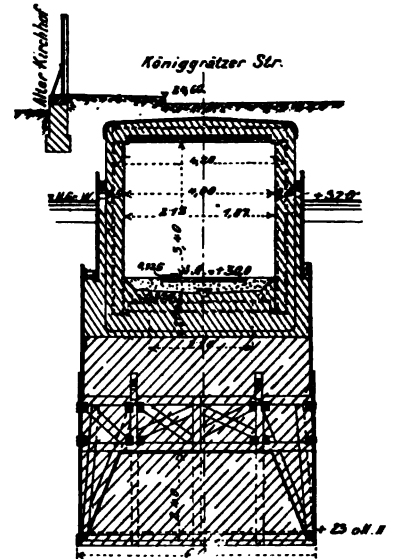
Querschnitt der Berliner Untergrundbahn unter dem Potsdamer Platz.
